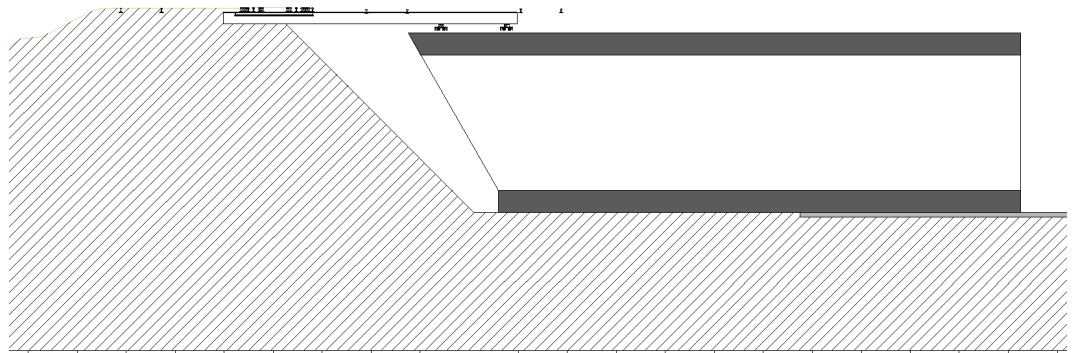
Situación de cálculo más desfavorable para las vigas de maniobra
